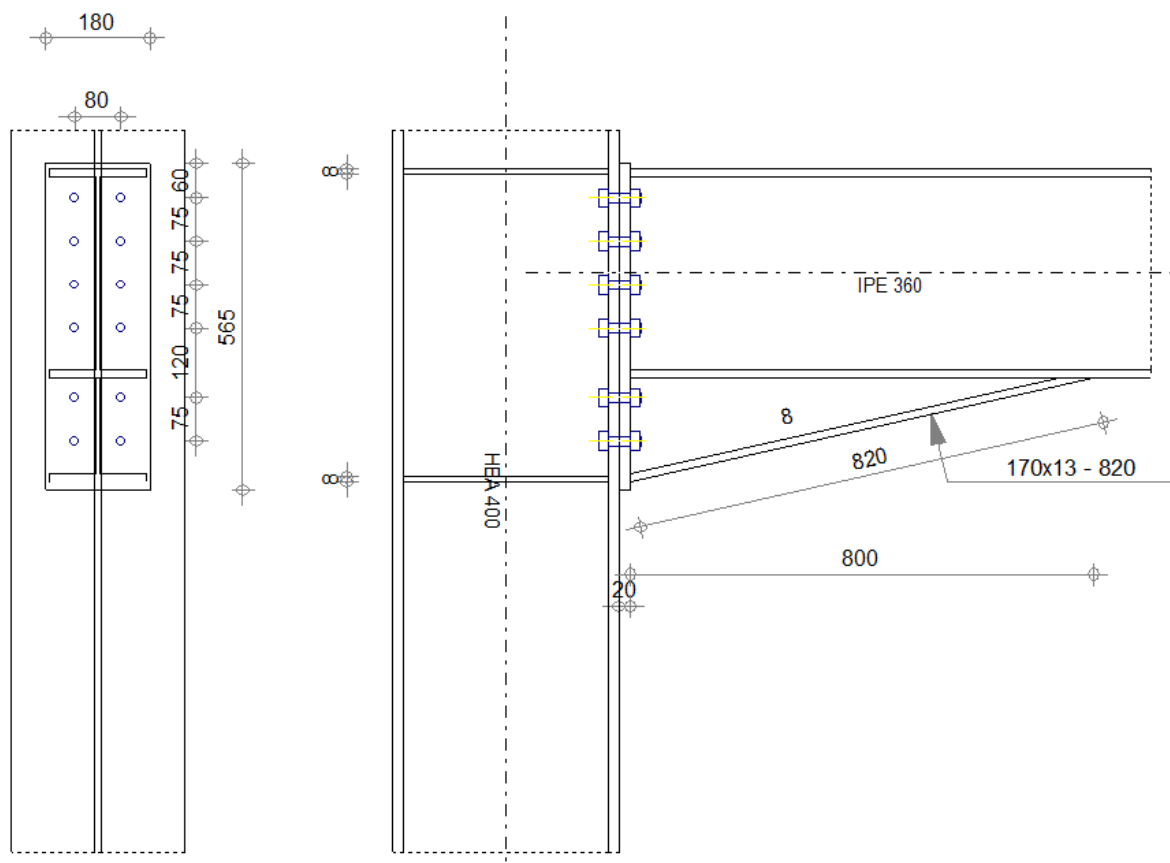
vue en plan de l'assemblage poteau- support de chemin de roulement.
